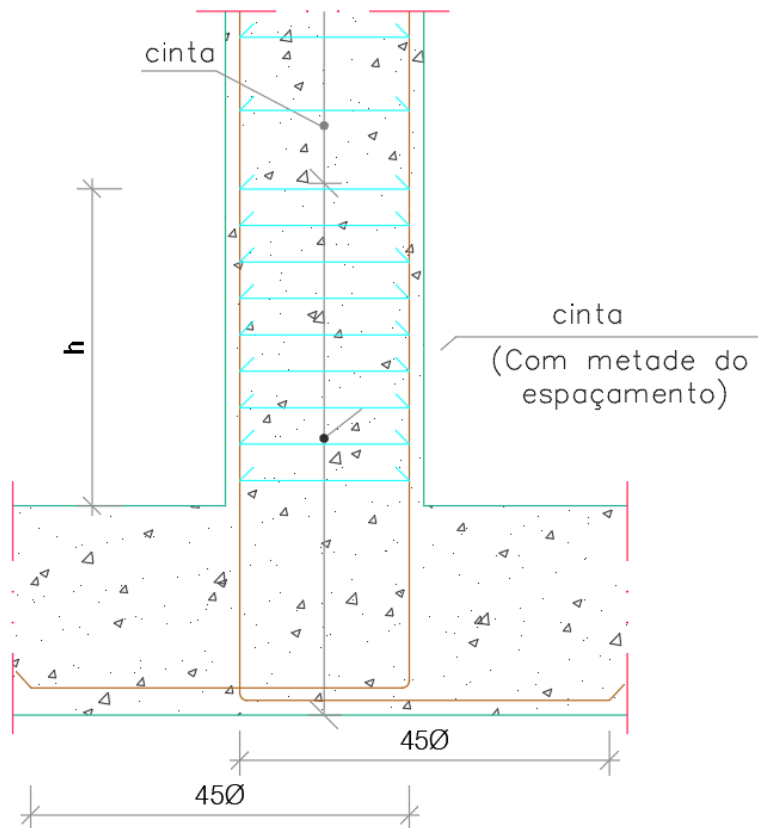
Arranque de armaduras em lajes, vigas e sapatas (Projeto de estruturas).
